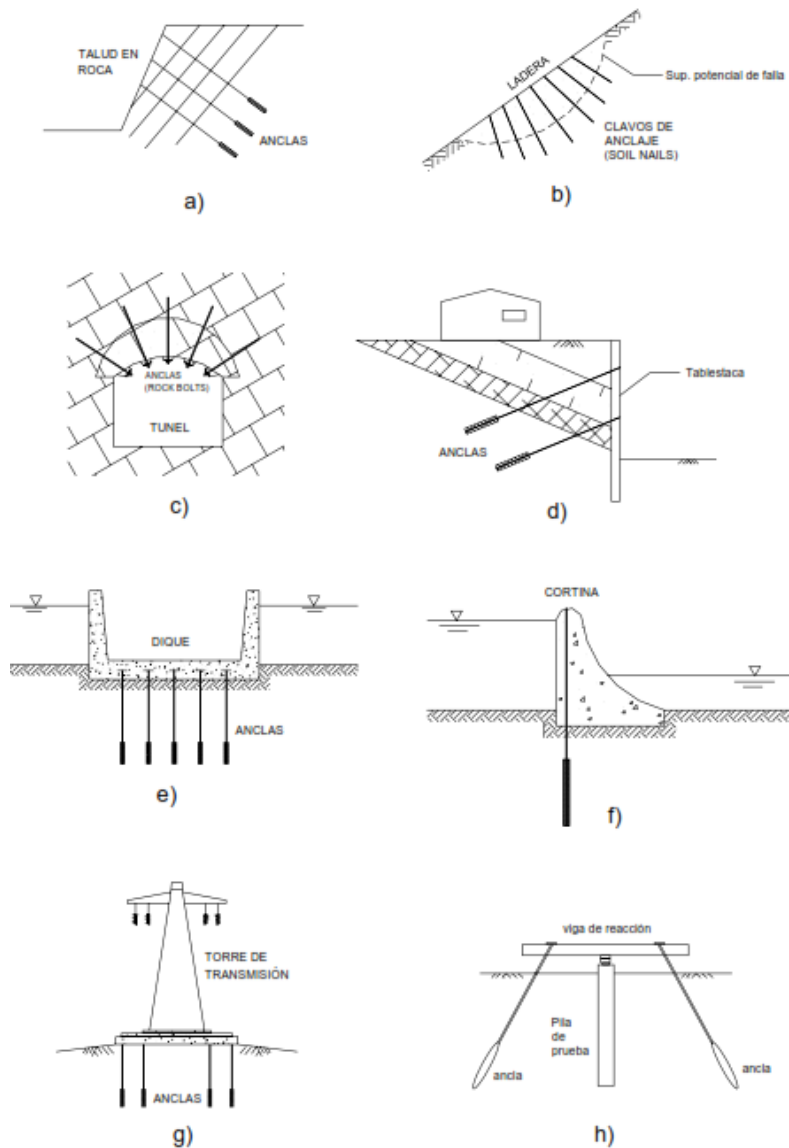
Aplicaciones más comunes de las anclas. Estabilización de taludes en suelo y roca (a); estabilización de laderas (soil nailing) (b); sujeción de bloques de roca (c); retención de tablestacas y muros pantalla (d); anclaje de estructuras sujetas a subpresión hidráulica (e); estabilización de estructuras sujetas a fuerzas de volteo y deslizamiento (f); estabilización de estructuras altas (g) y generación de fuerzas de reacción para marcos de carga (h).
